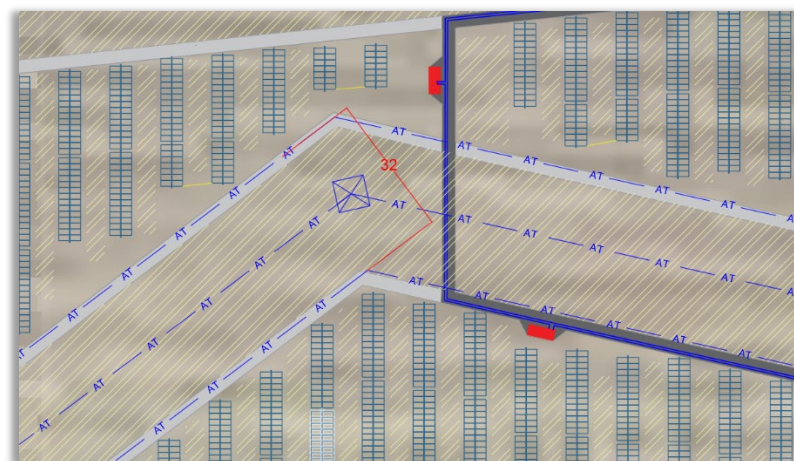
Layout Impianto con indicazione fasce di rispetto elettrodotto AT
